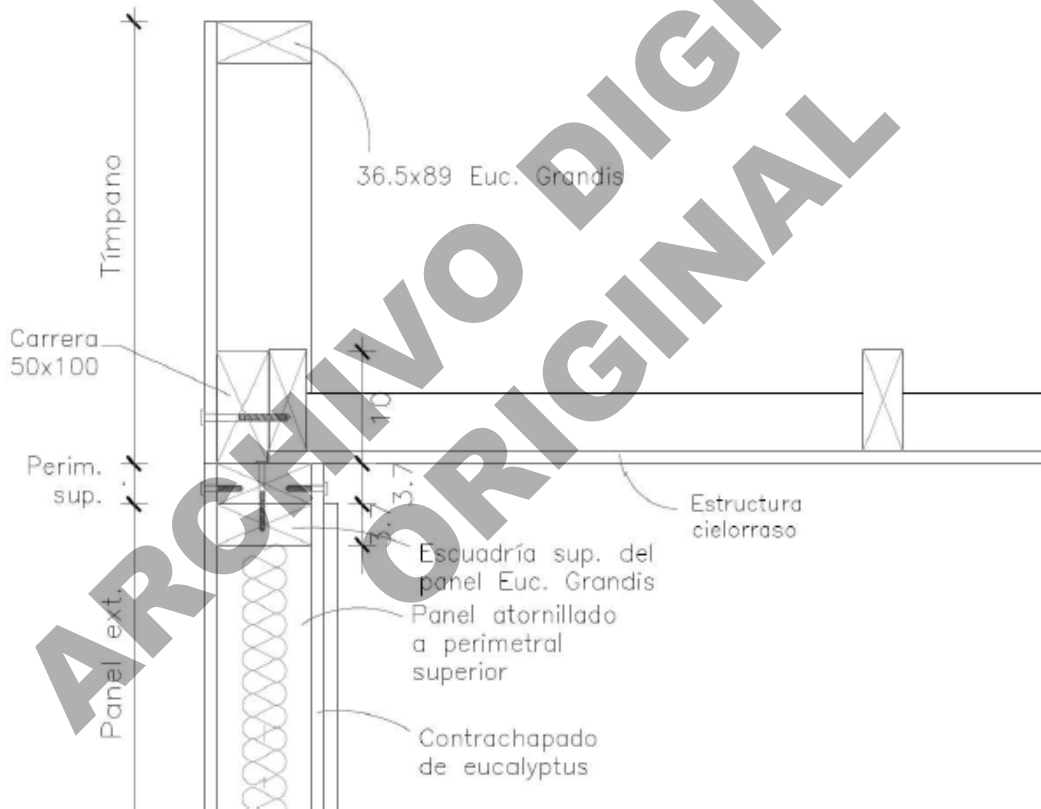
Corte por cabeza de paneles exteriores (en sentido transversal a la planta)
